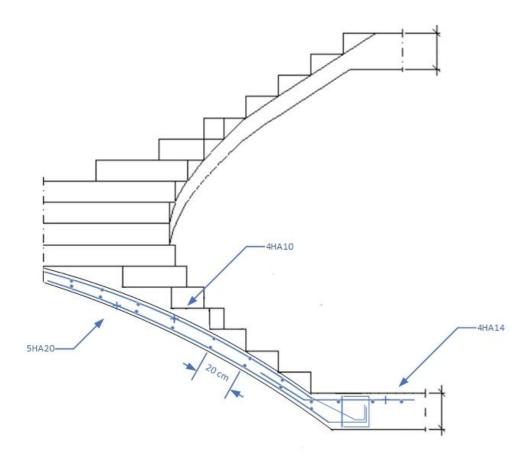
Ferraillage d'escalier hélicoïdal balance
